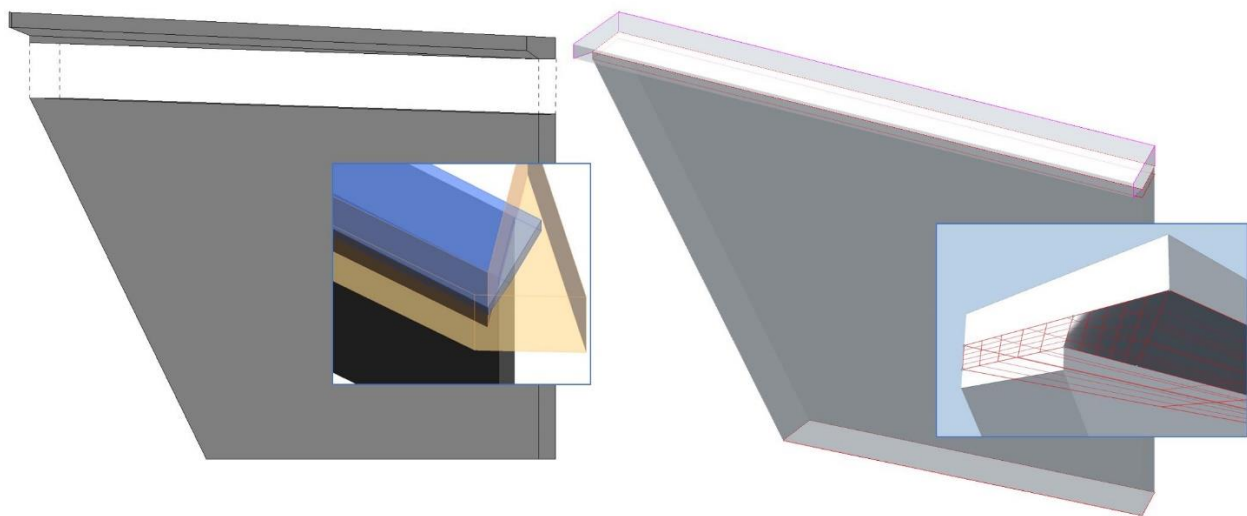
Modellierung eines Flügels in Revit (links) mit einem Detail zum *Abzugskörper* und in Allplan (rechts) mit Detail zu fehlerhaftem *Loft
